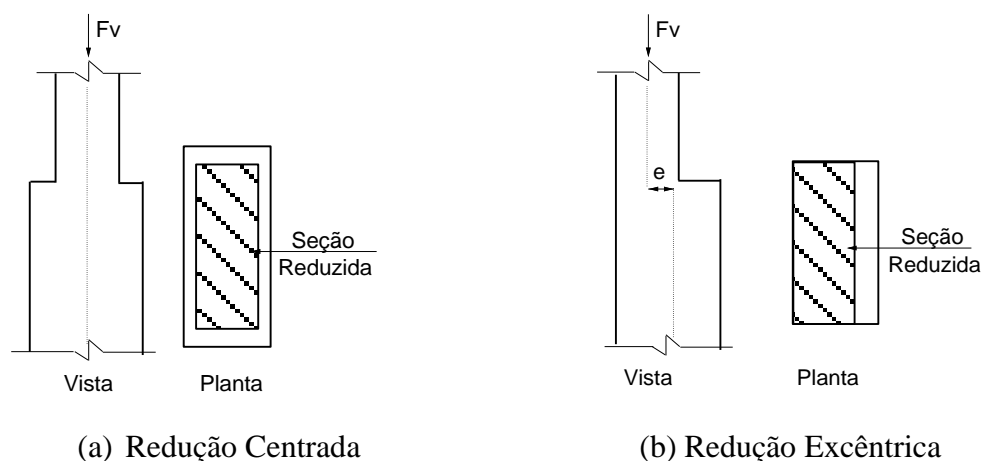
Tipos de Redução de Seção Transversal de Pilares
